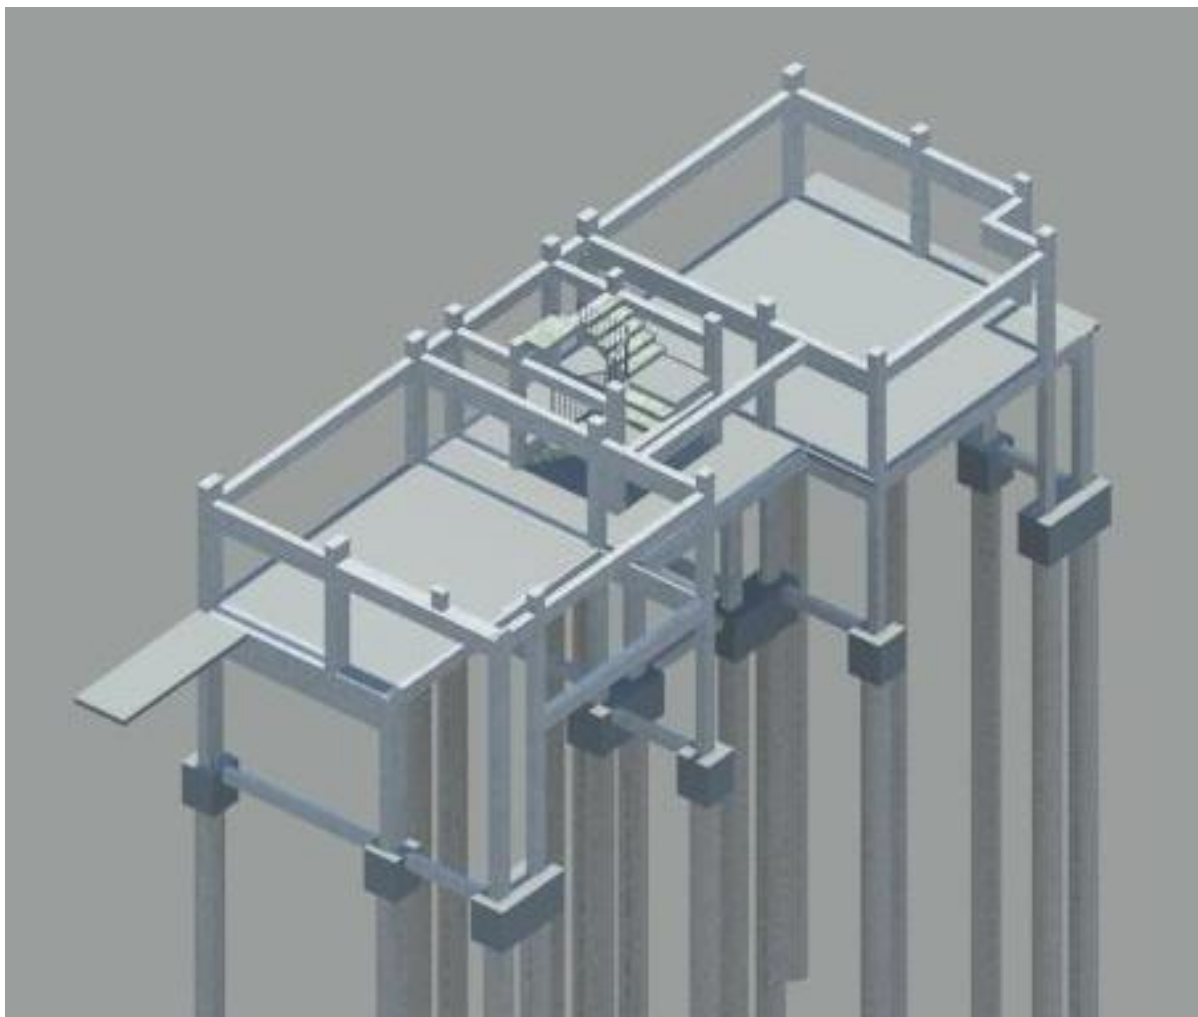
Perspectiva da estrutura do edifício com detalhe para as vigas do primeiro pavimento
